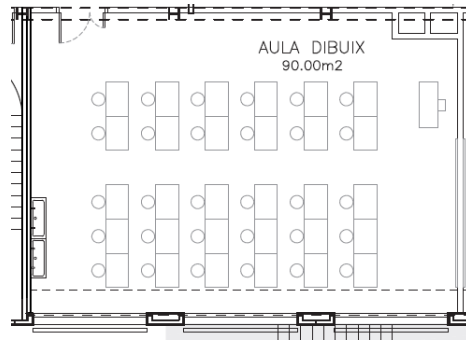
Planta del aula de dibujo. Fuente: Planos memoria proyecto.
